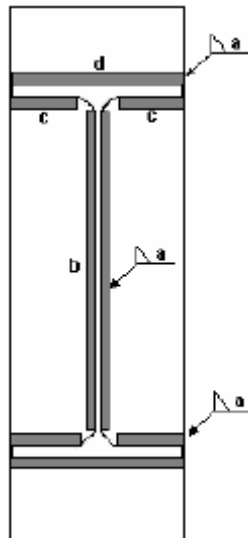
Representação esquemática dos cordões de soldadura da ligação da viga à chapa.
